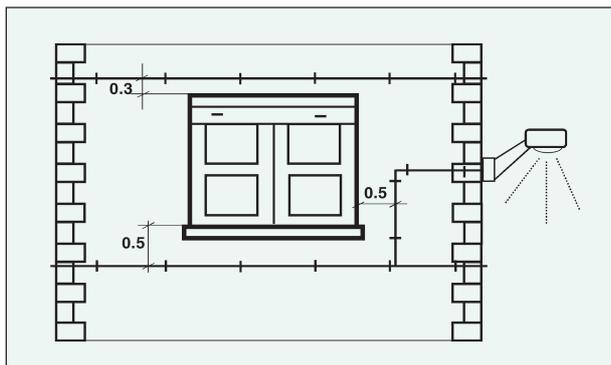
Paso por zonas. Distancia de los conductores aislados posados a ventanas.
